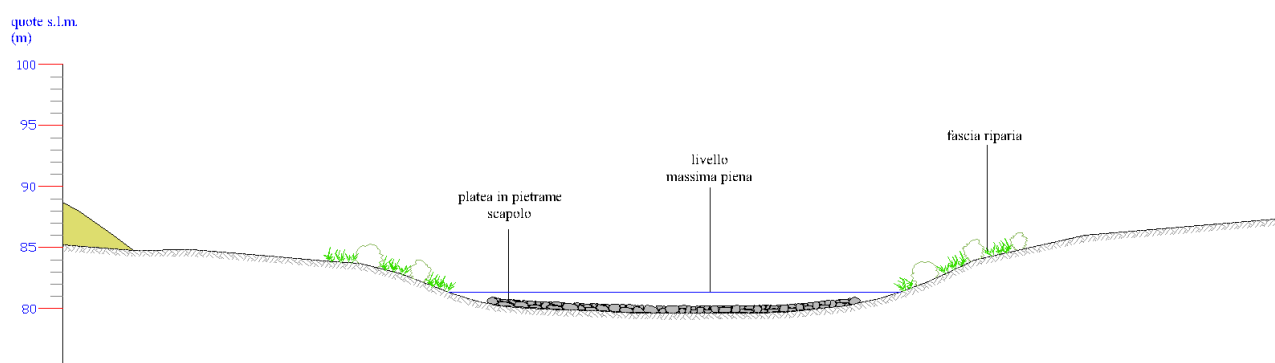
PLANIMETRIA: STRALCIO DELLA TAVOLA D5 - REALIZZAZIONE DI PLATEE DI DISSIPAZIONE IN PIETRAMME SCAPOLO - PLANIMETRIA - AREA 10 - SEZIONI, ALLEGATA AL PROGETTO DEFINITIVO 2012
